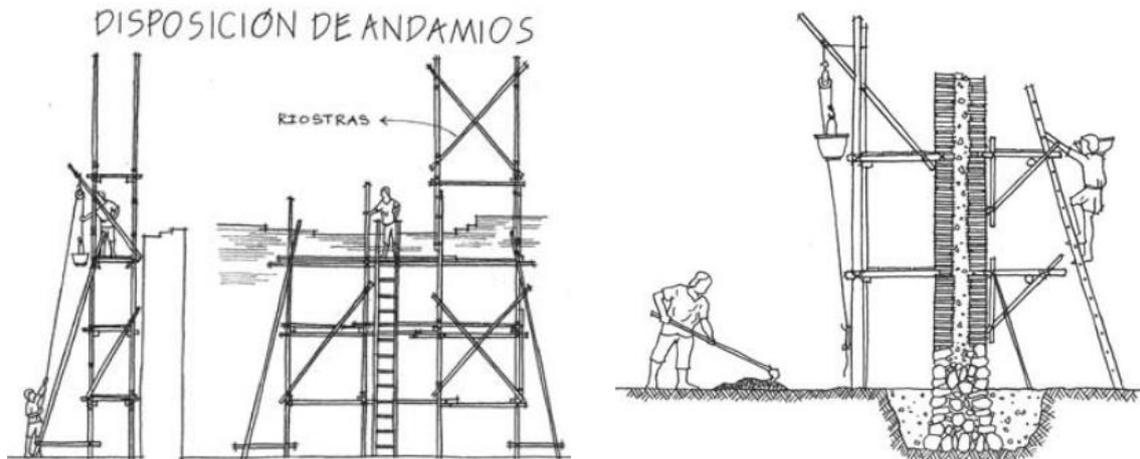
Disposición del andamiaje en una obra y sección de un muro en construcción con el andamiaje anclado al muro, que posteriormente se corta. Dibujo realizado por Jorge Arruga Sahún.
